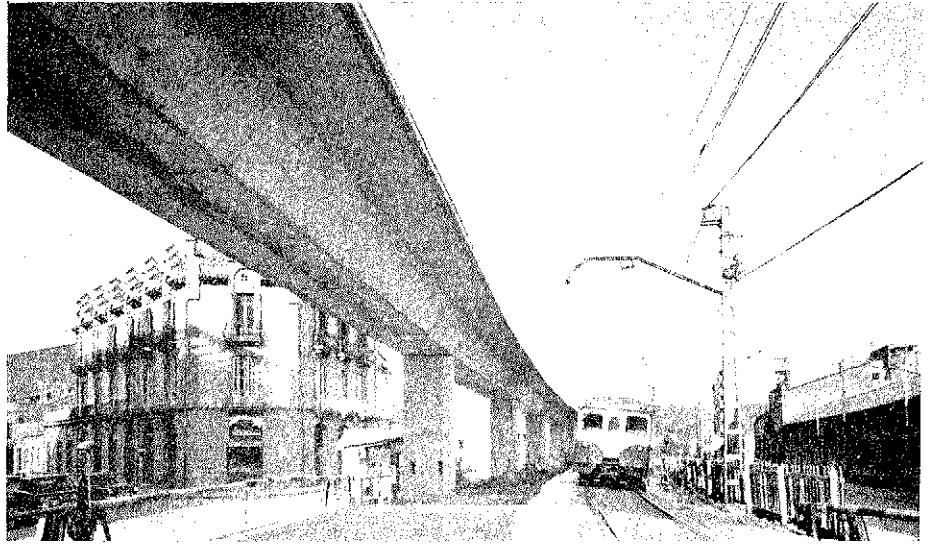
Viga continua de sección trapecial con voladizos.
